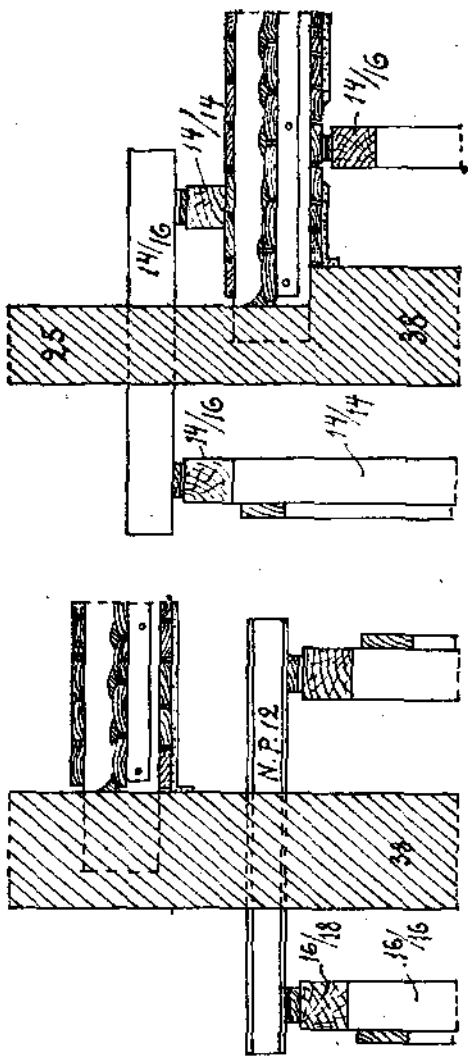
Устройство креплений и стоек для равномерного распределения нагрузки для перекрытия.
